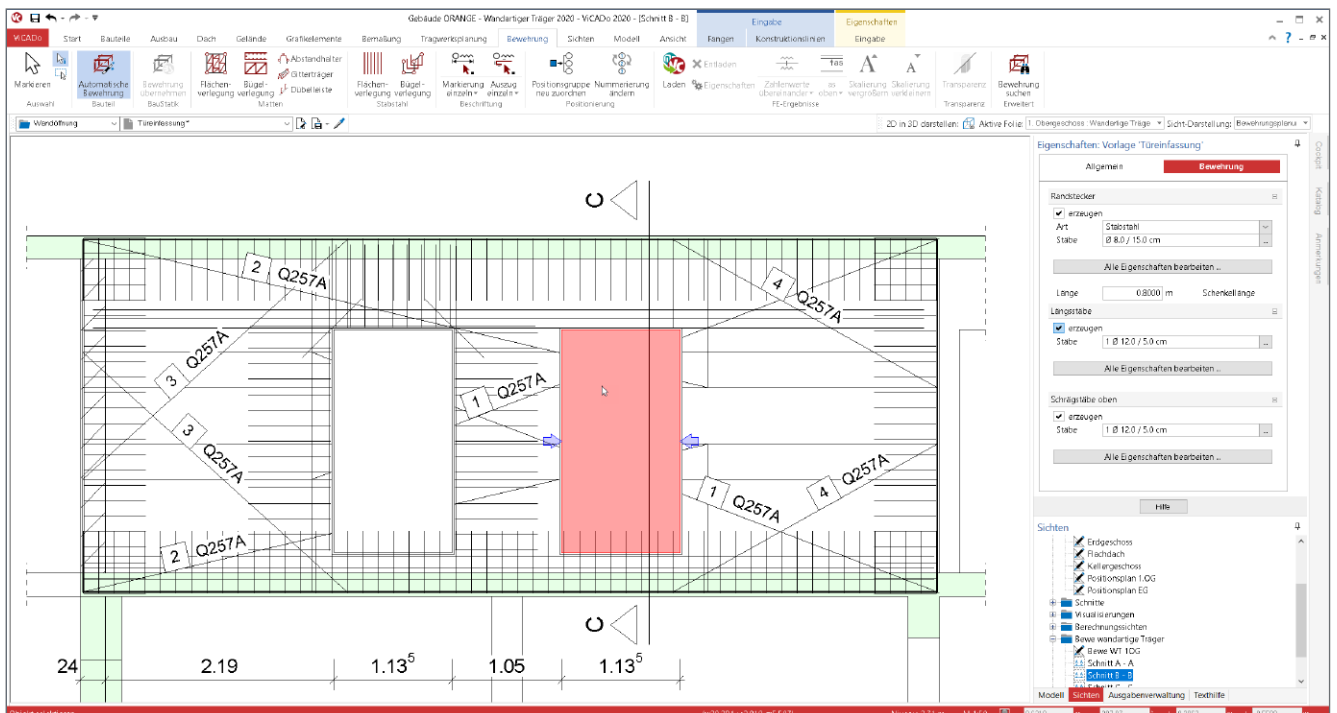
Automatische Bewehrung zur Modellierung der konstruktiven Bewehrung der Aussparungseinfassung
